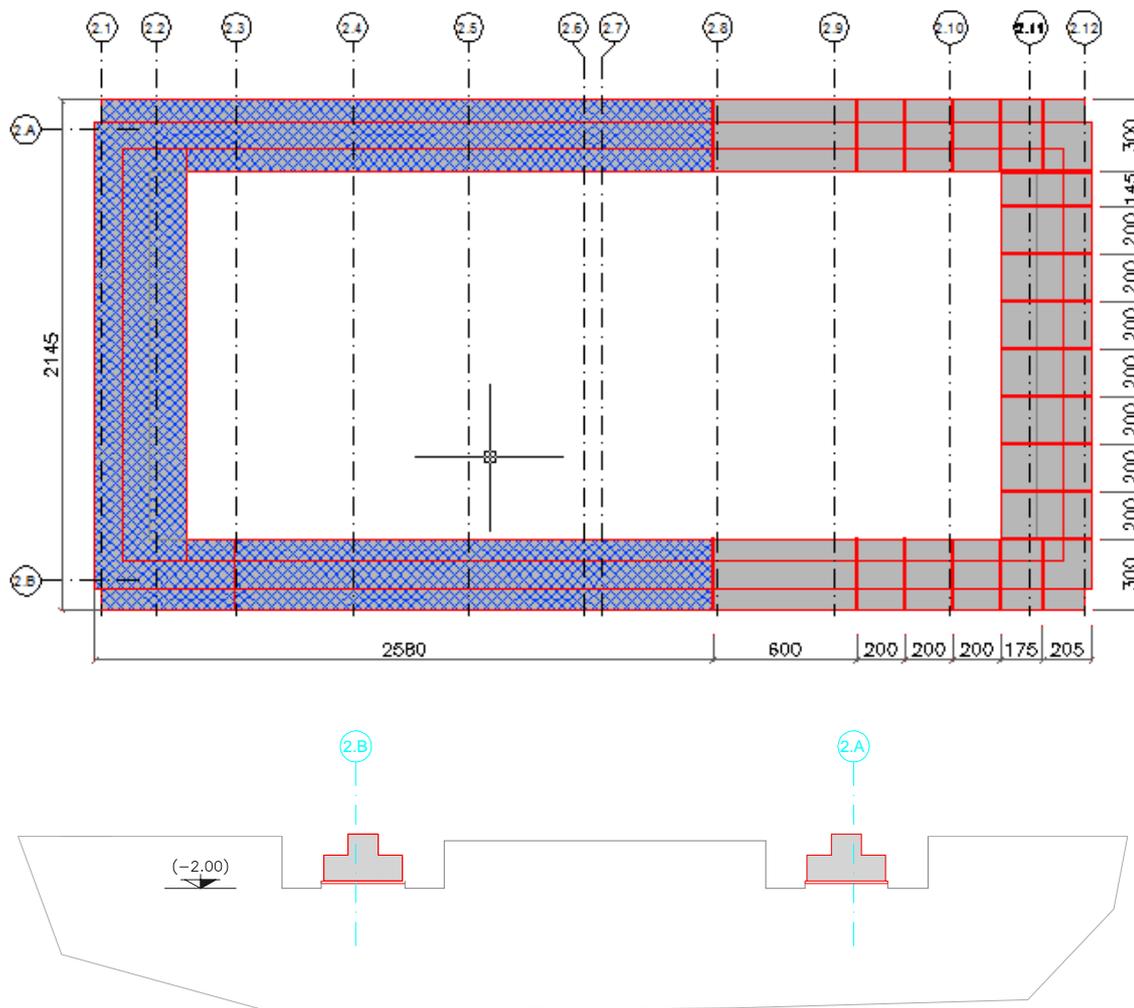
Taglio e rimozione sezioni periferiche (travi rovesce) fondazione (Pianta e Sezione)
